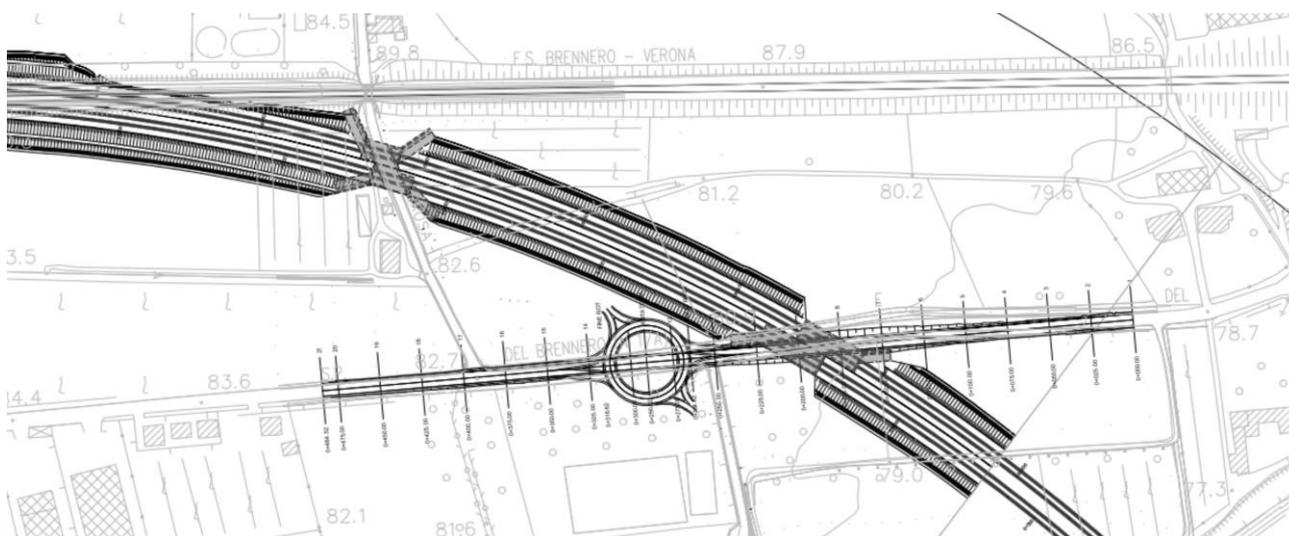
NV09 – Stralcio planimetrico su rilievo di Via del Brennero
